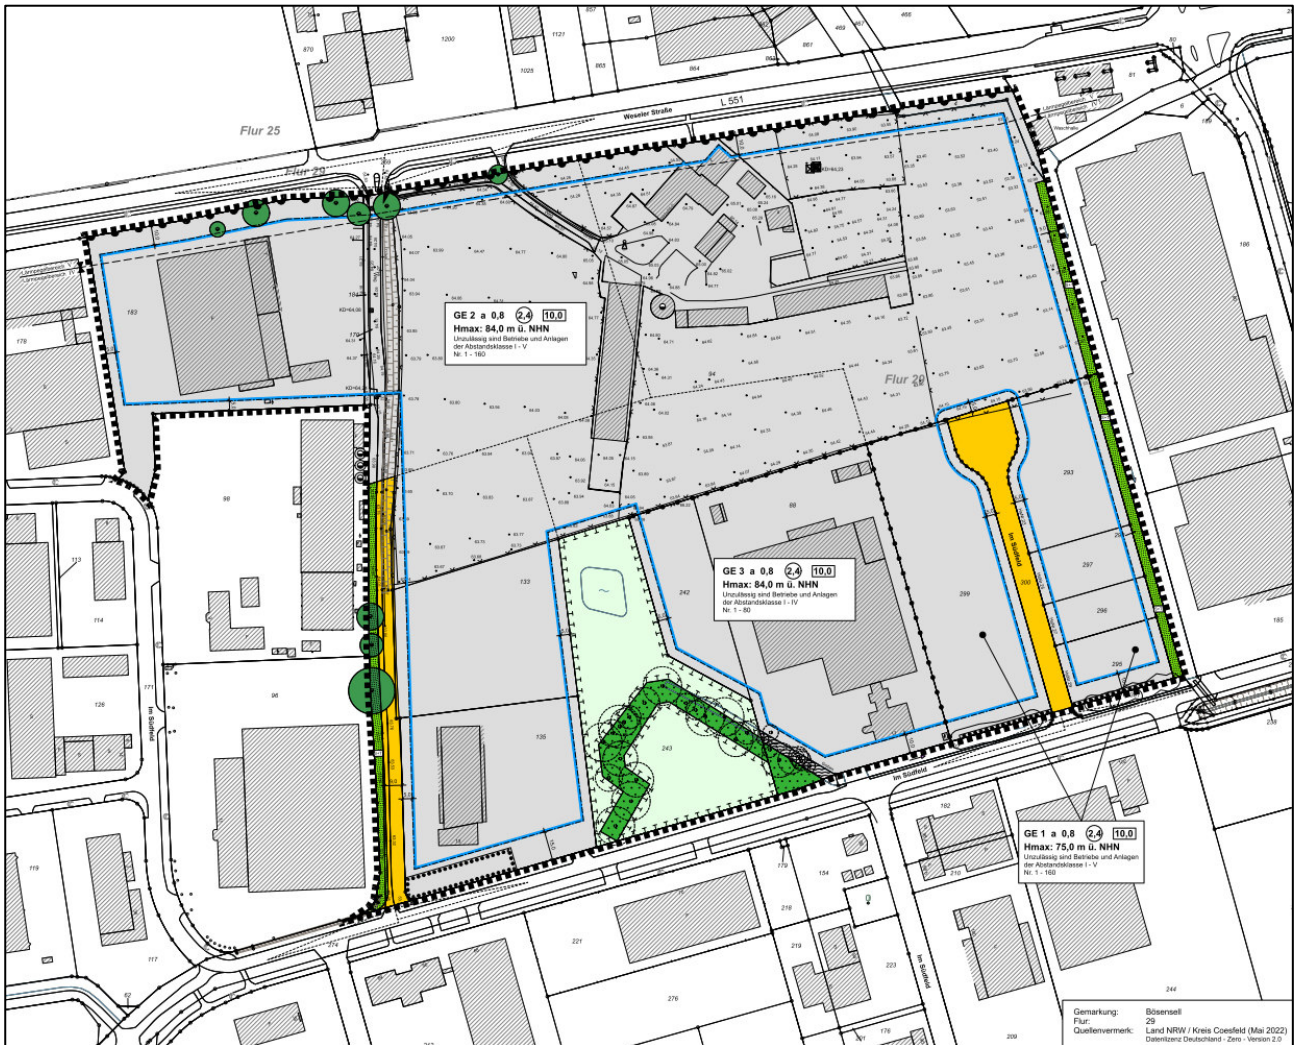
Bebauungsplan „Südlich der Weseler Straße“, Stand 14.09.2023
